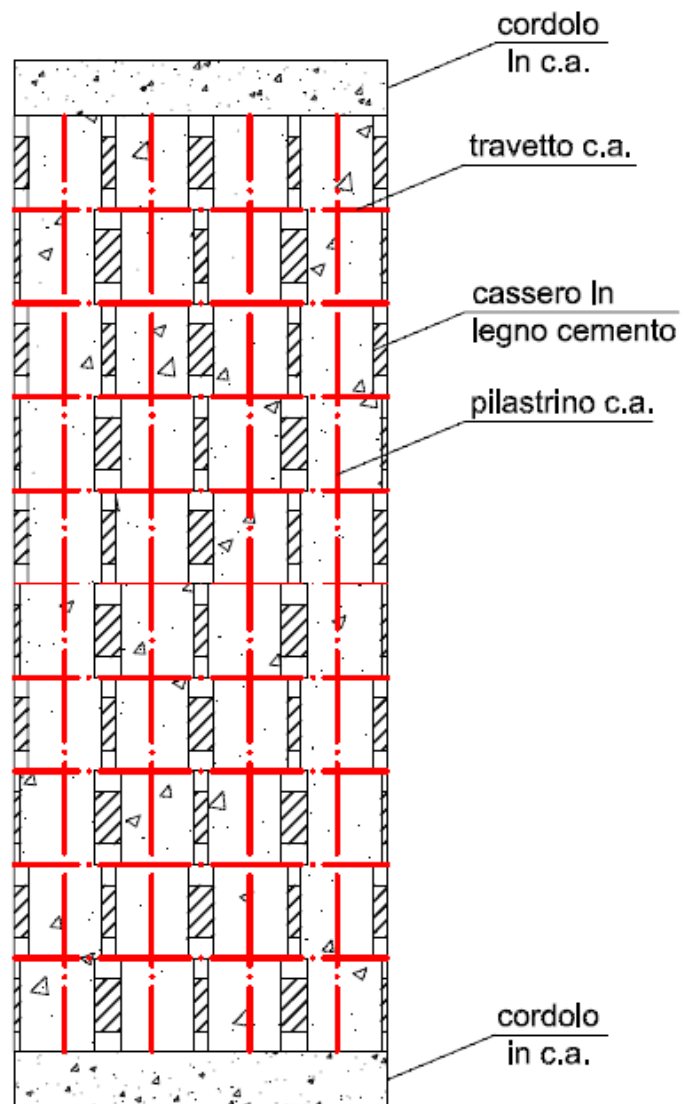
Elementi portanti verticali (pilastrini) ed orizzontali (travetti) all'interno del pannello soggetto a prove di compressione.
